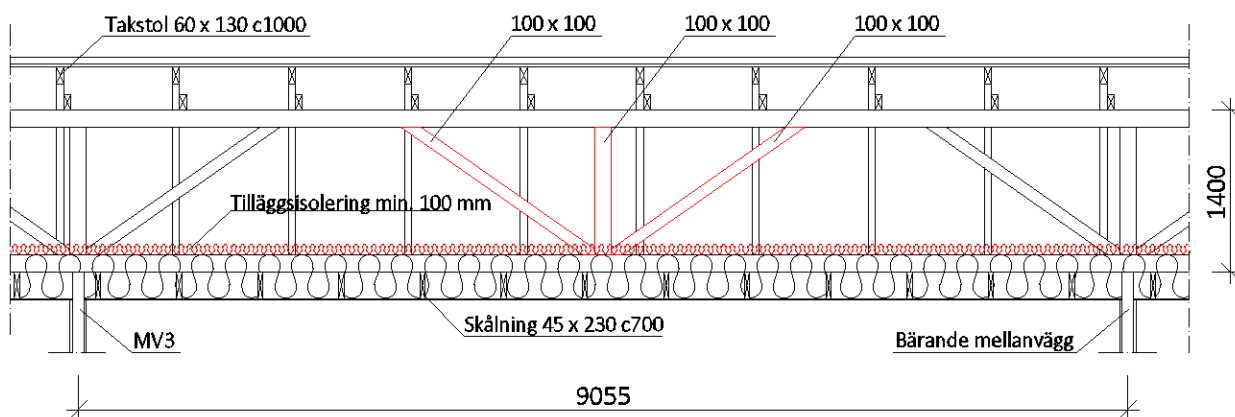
Exempel på hur mellanbjälklaget fästs i väggkonstruktionen. Nya konstruktioner är markerade med rött.
